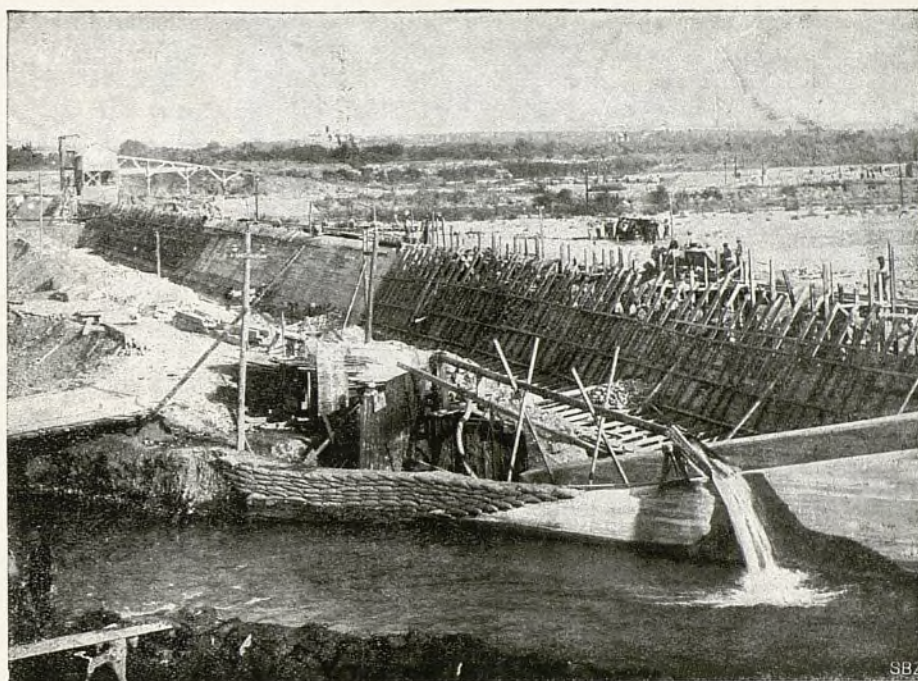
Muro de embalse en construcción, en último término paso flotante y desagüe.
